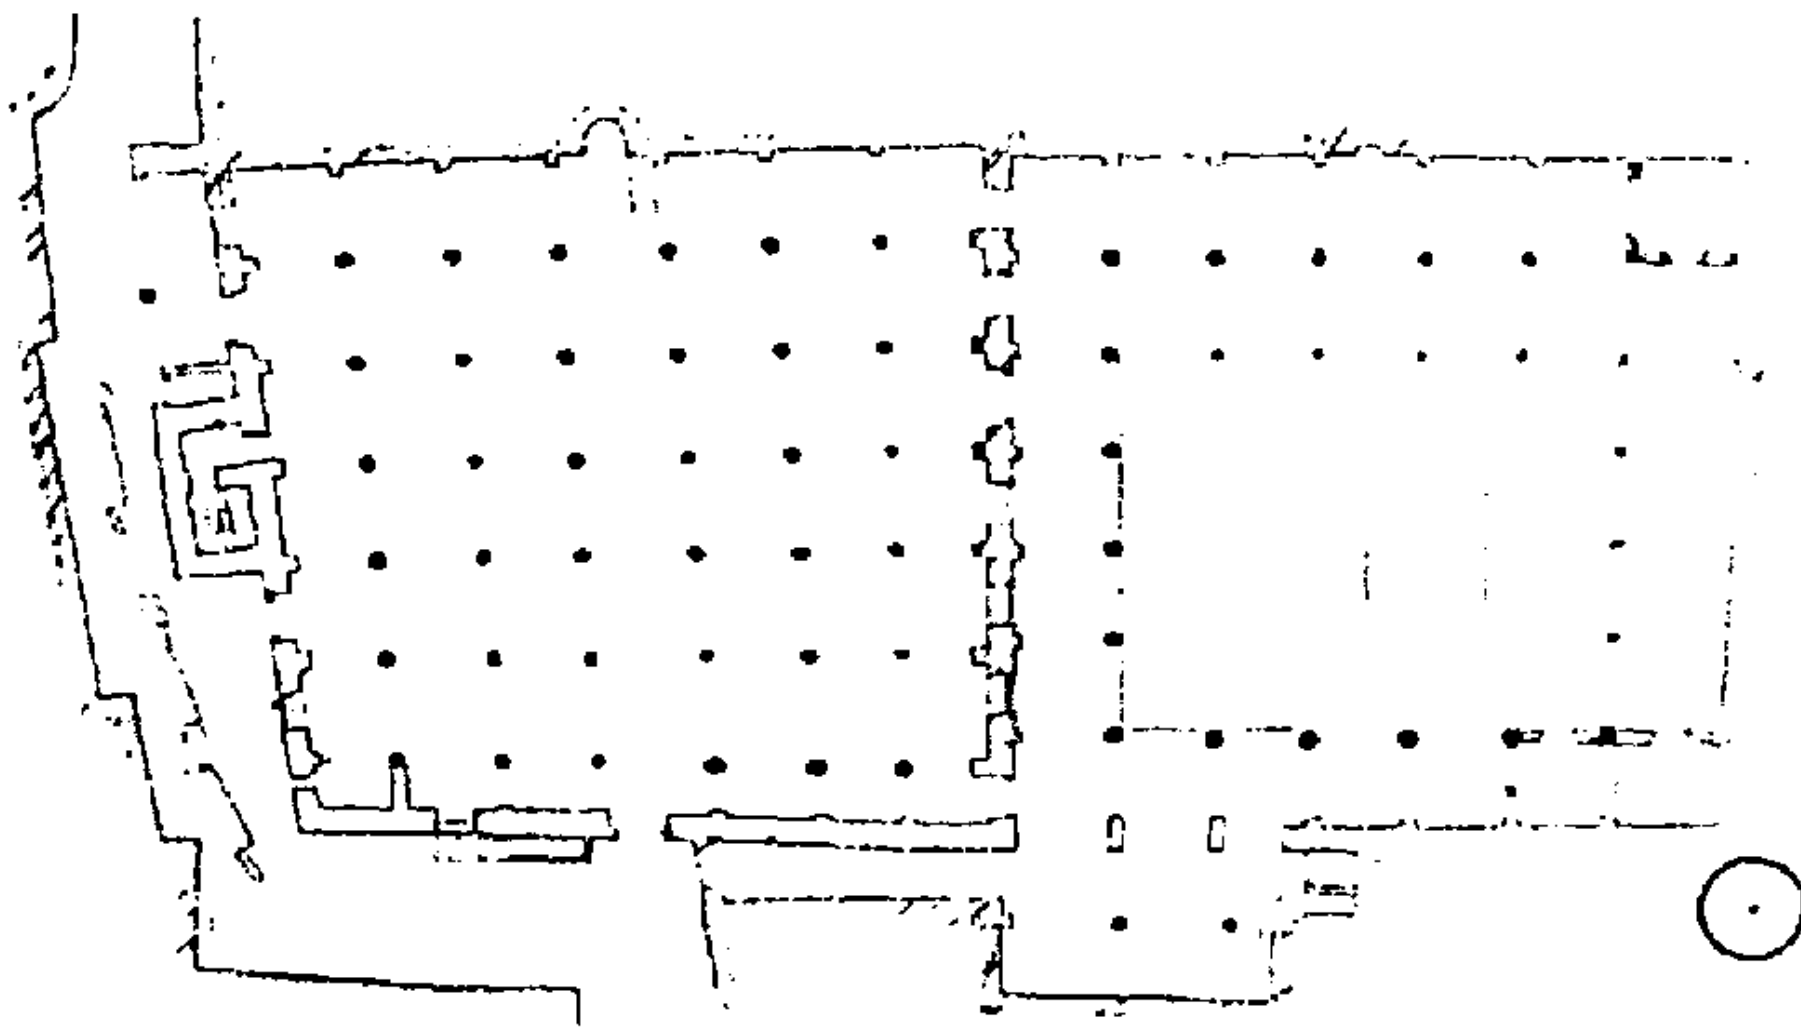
مسقط أفقي لمسجد بتلیس عن أصلاناب .
